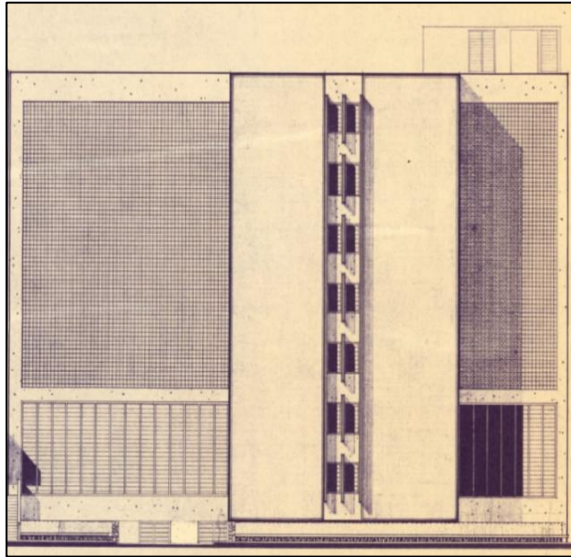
Elevación fachada principal Edificio del ala norte de la Facultad de Medicina (Sector Este). (Plano de la edificación, 1965)
